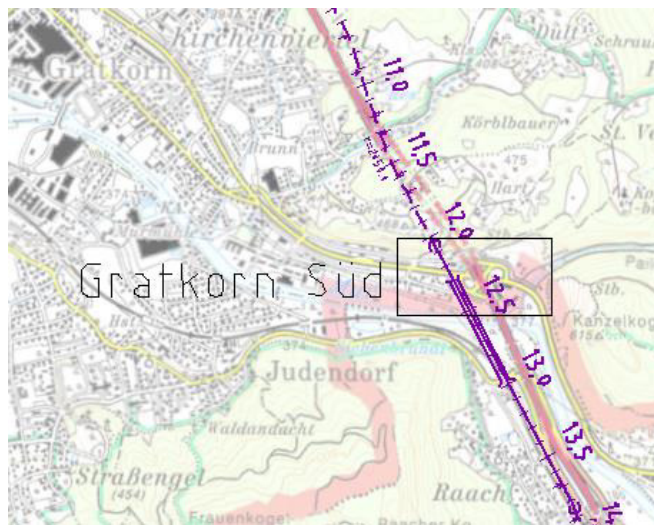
Lageplan Gratkorn Süd Variante „Gösting“
